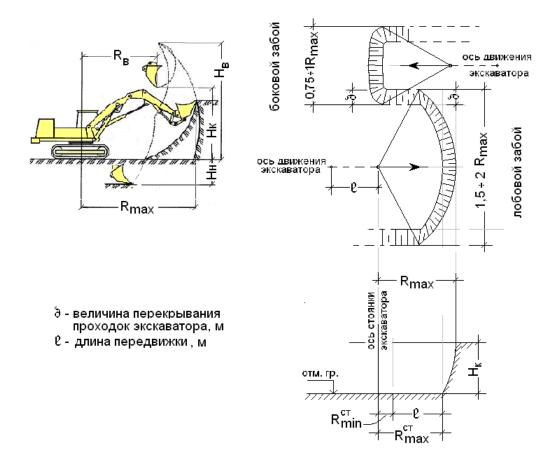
Схема разработки грунта экскаватором с оборудованием прямая лопата
